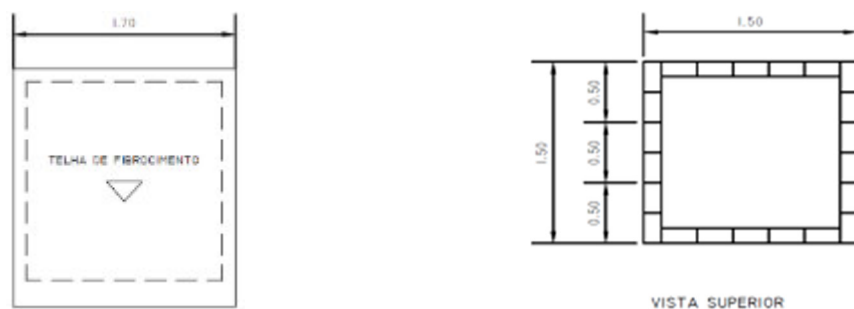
e 4: Vista superior e planta baixa dos protótipos.
